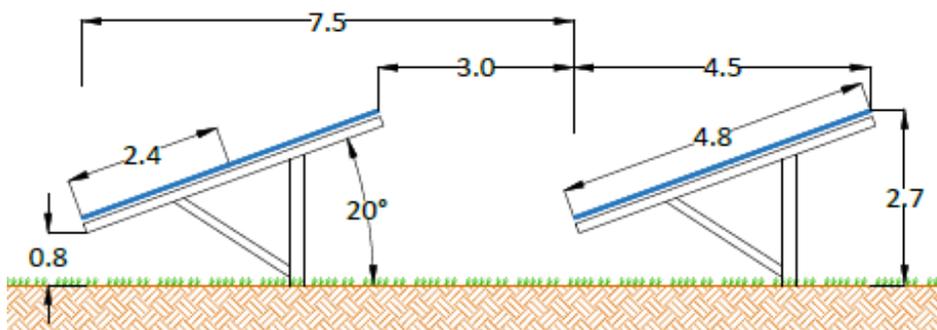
Détail des panneaux et structure PV extrait du permis de construire — CLT architectes – 12/10/2021
